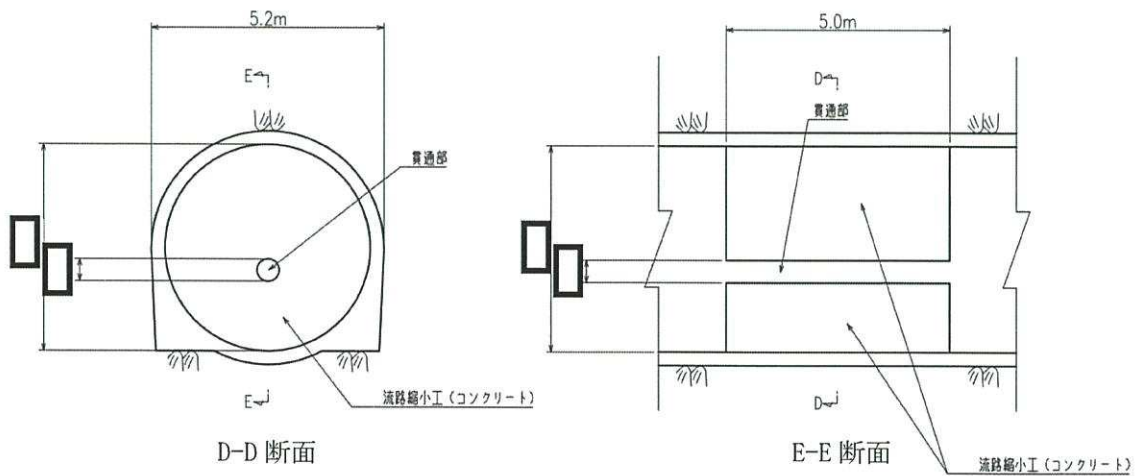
取放水路流路縮小工（第1号機放水路）の断面図
